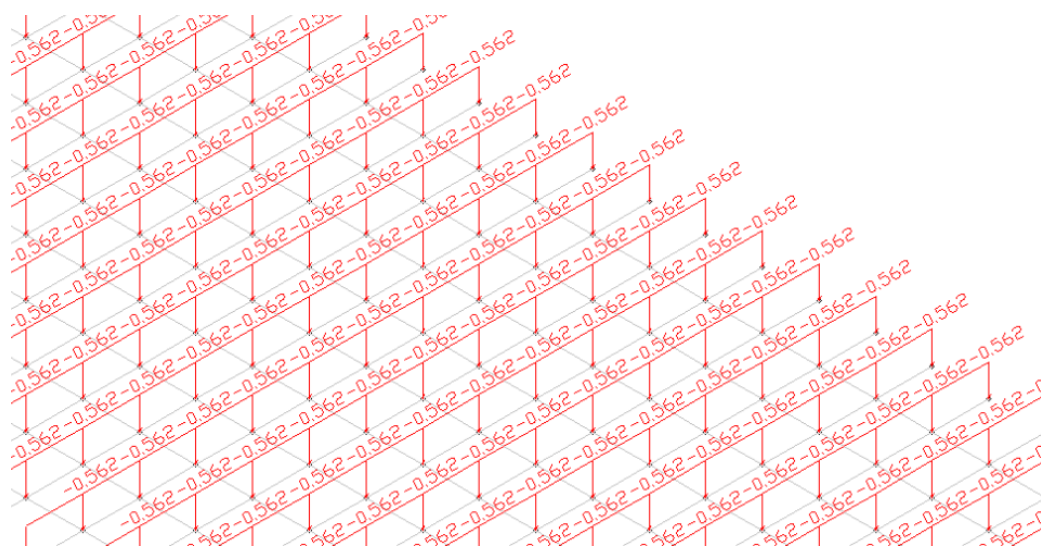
Vista 3D em zoom – Carregamento – Peso Próprio (g1) da Laje Inferior
